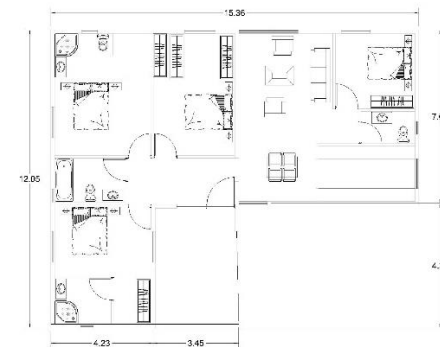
Planta de distribución arquitectónica 136.44 m² + 15.08 m² de porche, con dimensiones generales de 15.36 m. de longitud por 12.05 m de ancho y un total de 151.52 m² de construcción (HOME 3, 2016).
